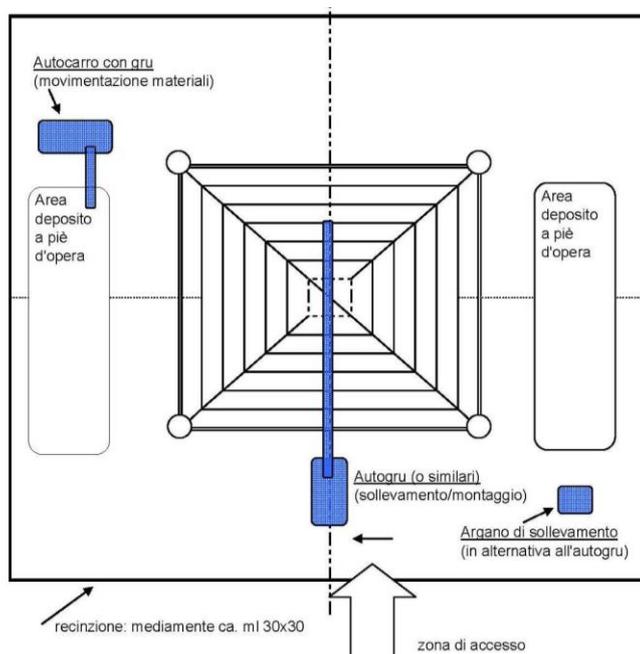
Planimetria dell'area di microcantiere (linea 380 kV) - fase di lavoro: montaggio sostegno
